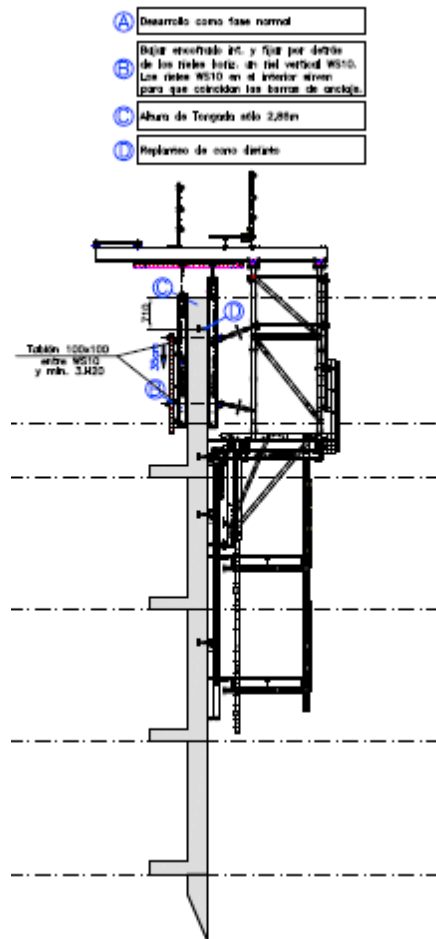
Esquema 2 y 3ª fase trepado en planta técnica.2005.Raúl López
